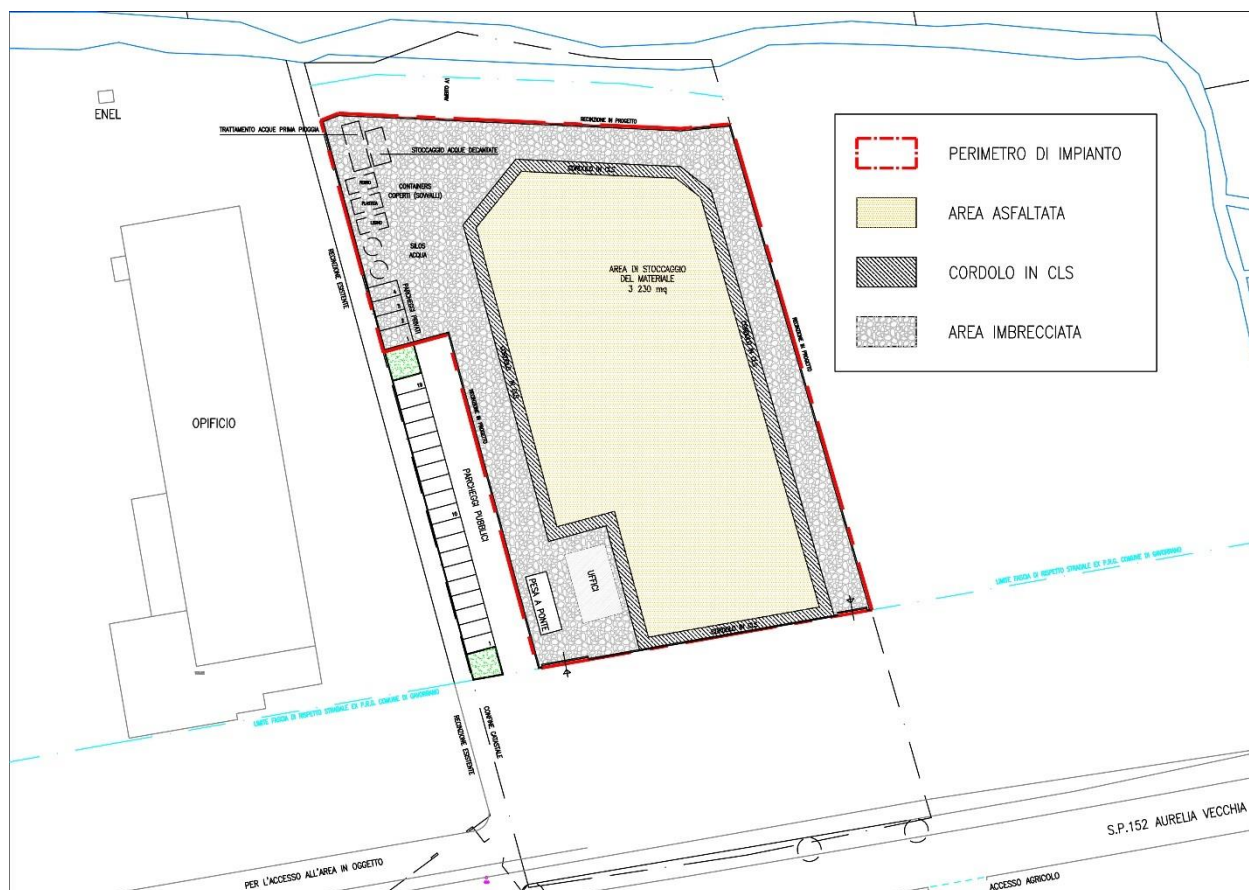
ESTRATTO ELABORATO GRAFICO TAV.02 – PLANIMETRIA DELLO STATO ATTUALE
